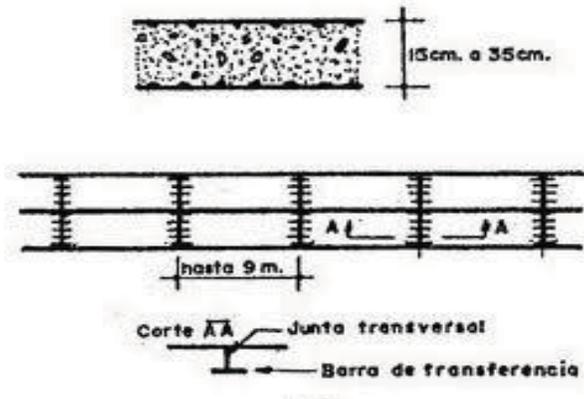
Estructura de un pavimento rígido con barras de transferencia de cargas.
